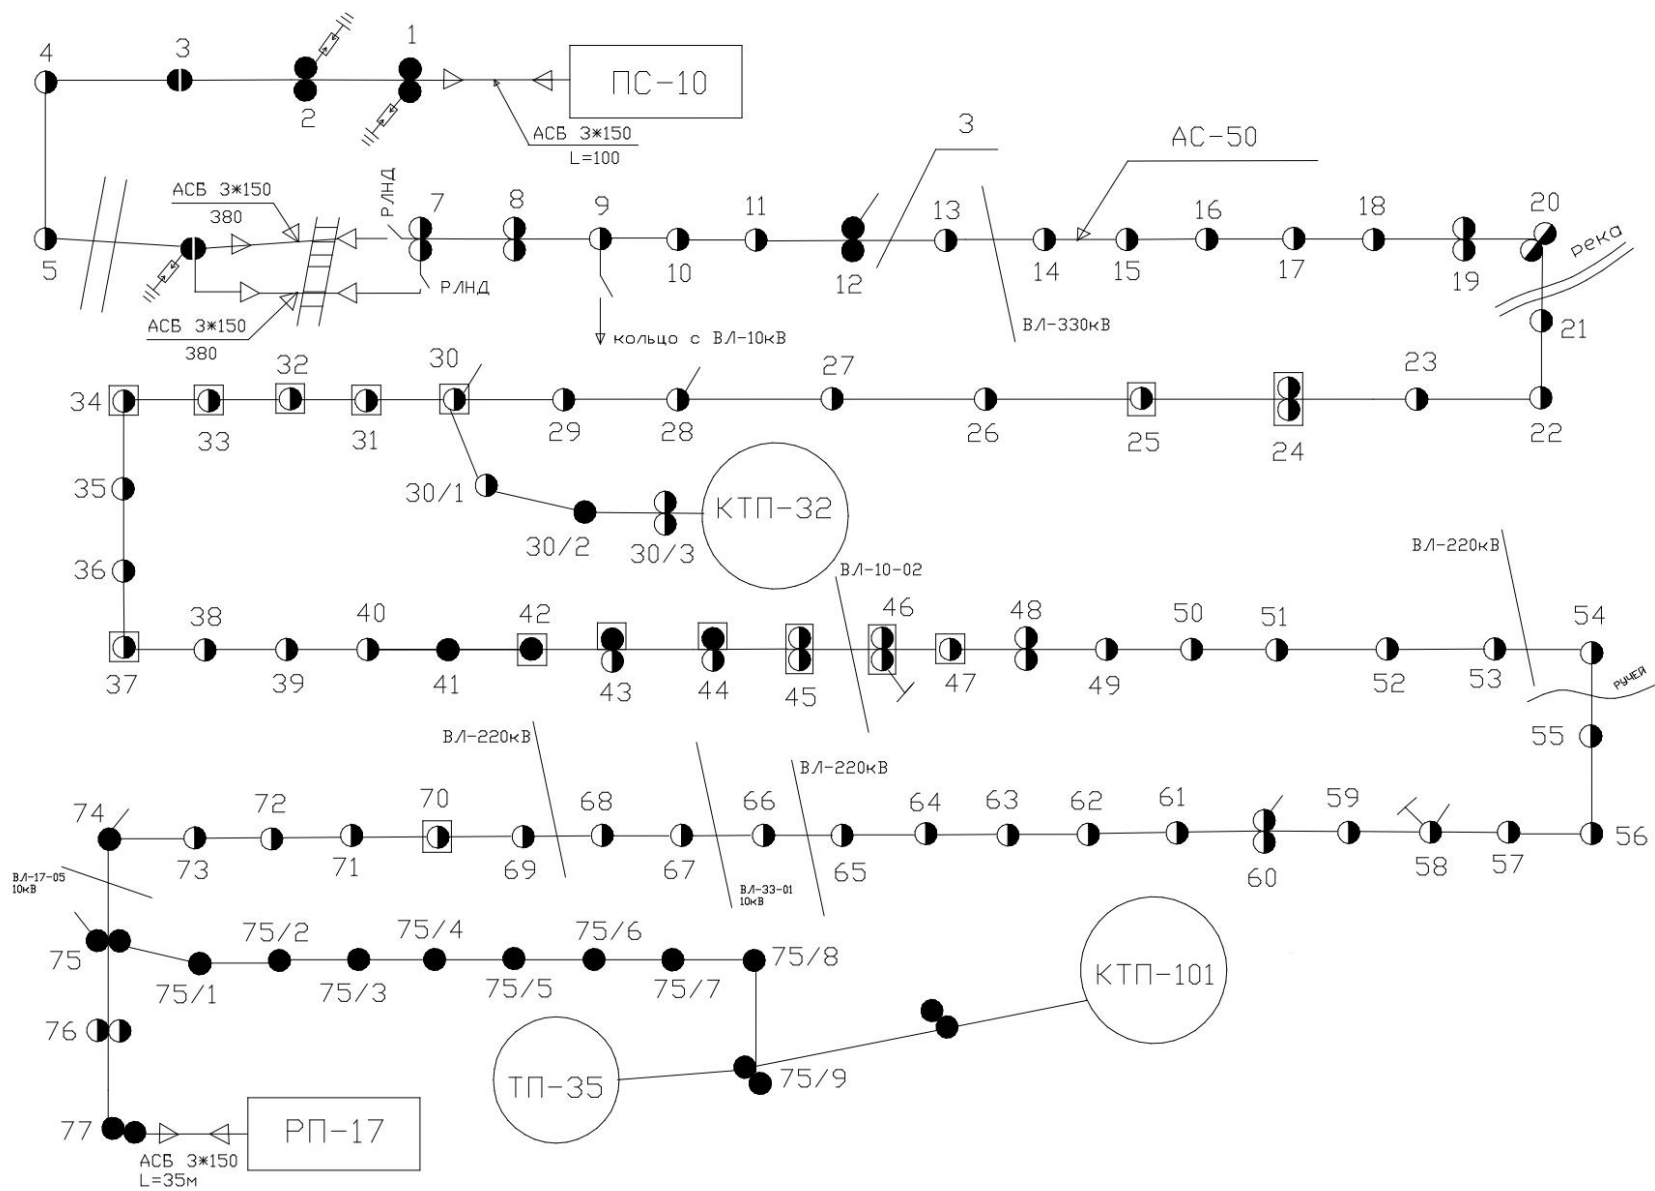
«Поопорная схема воздушно-кабельной линии Л-10-20
